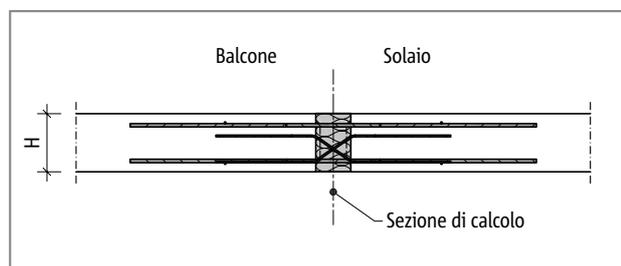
Schöck Isokorb® tipo DXT: sistema statico
